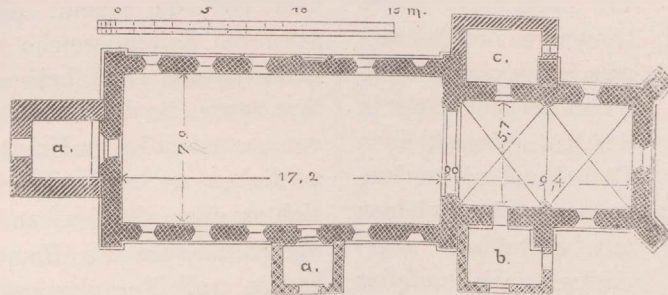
Grutta. Grundriss der Kirche.
